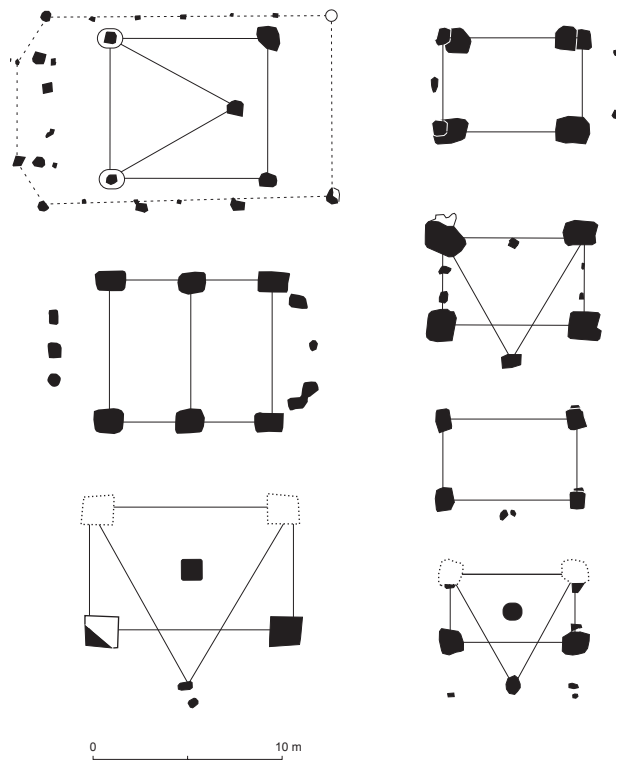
plans de constructions à bâti porteur quadrangulaire, laténiennes (les trois premières) et antiques (éch. 1/200) (C. L.).
